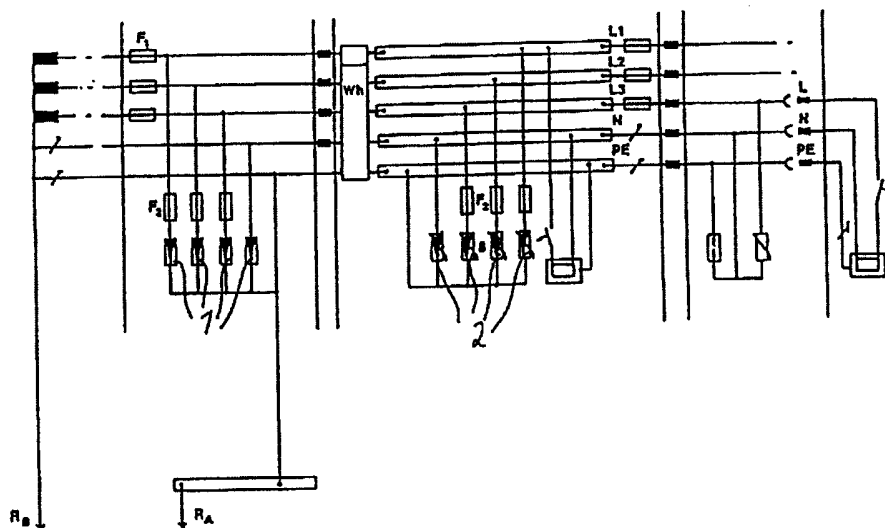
Zapojení přístrojů k ochraně před přepětím v rozvodné soustavě
